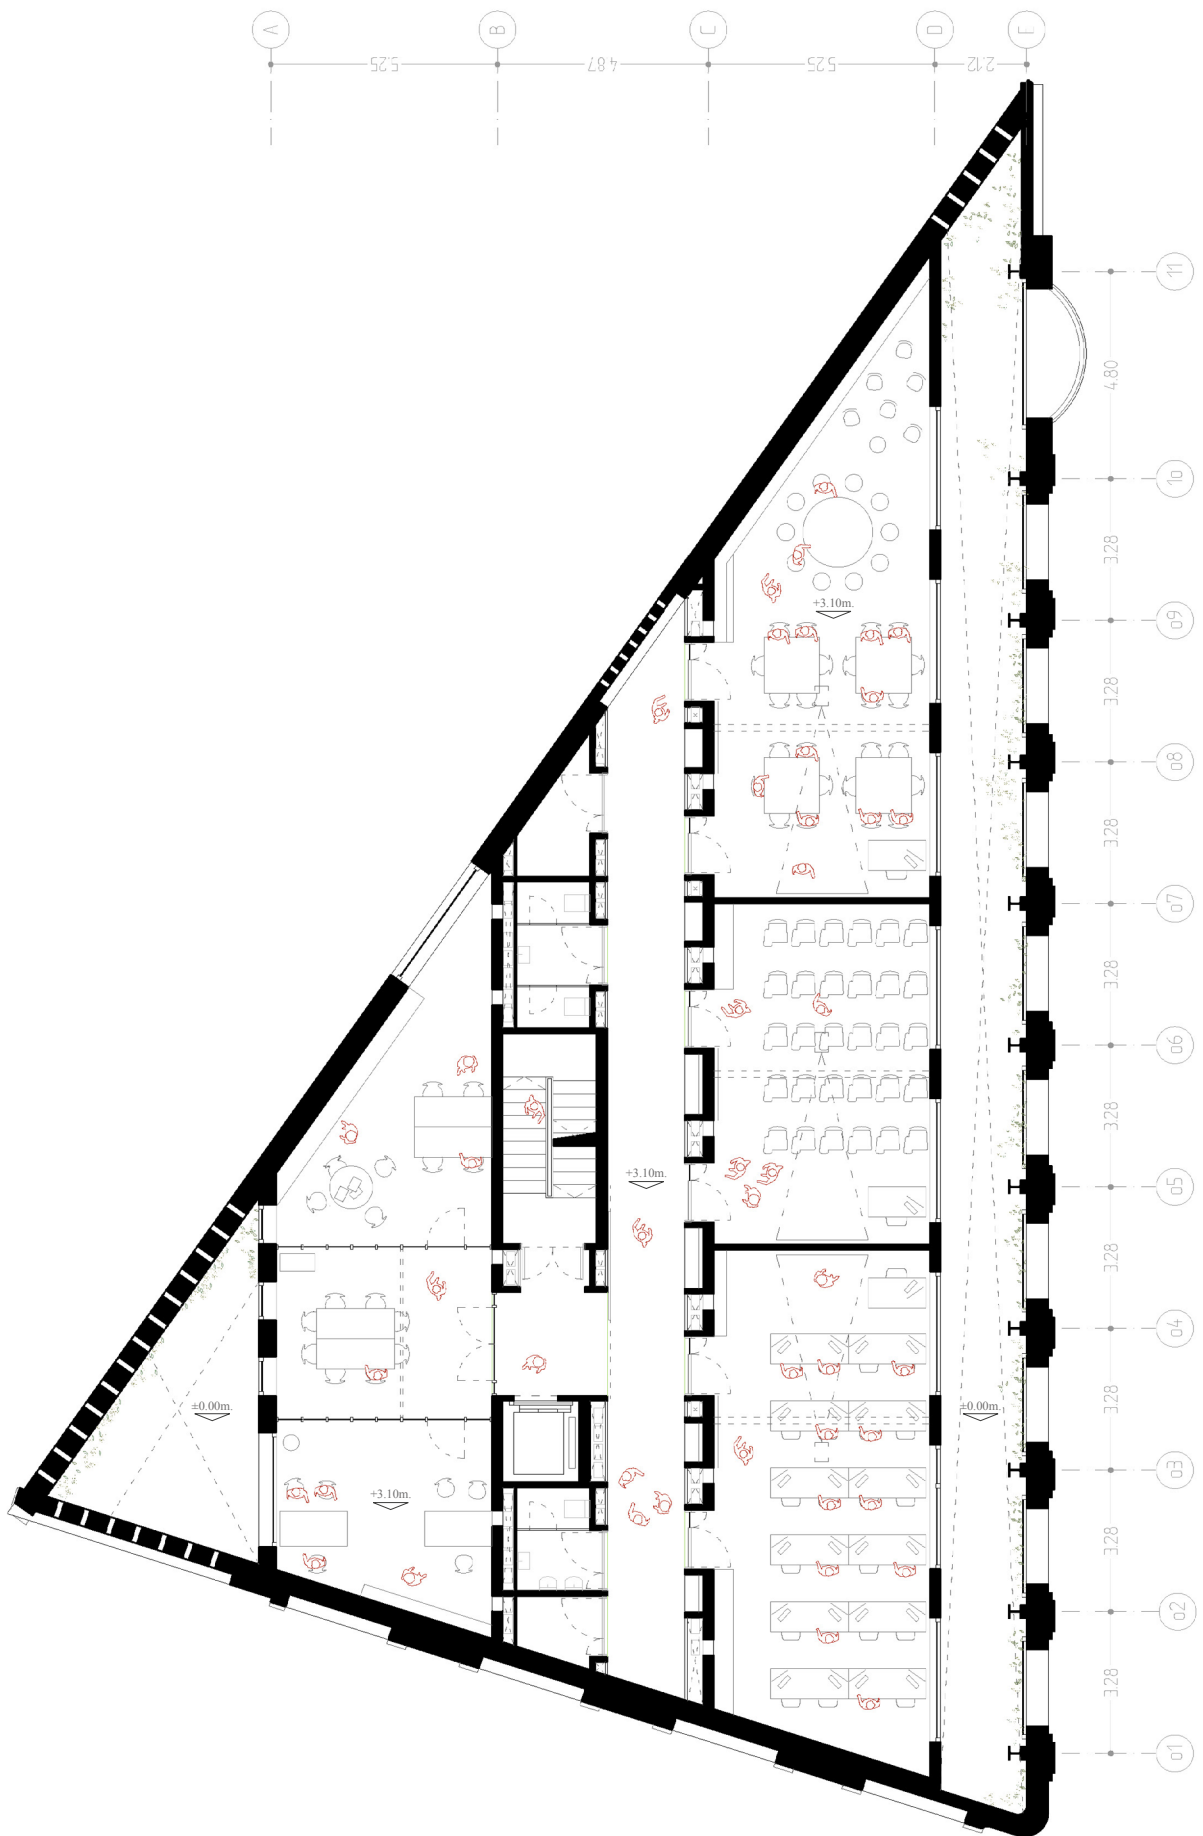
Planta Tipo (nivel representado: P. Primera). Centre Cívic Cristalerías Planell, H Arquitectes, Barcelona, España, 2016 (Fuente: Elaboración propia)
